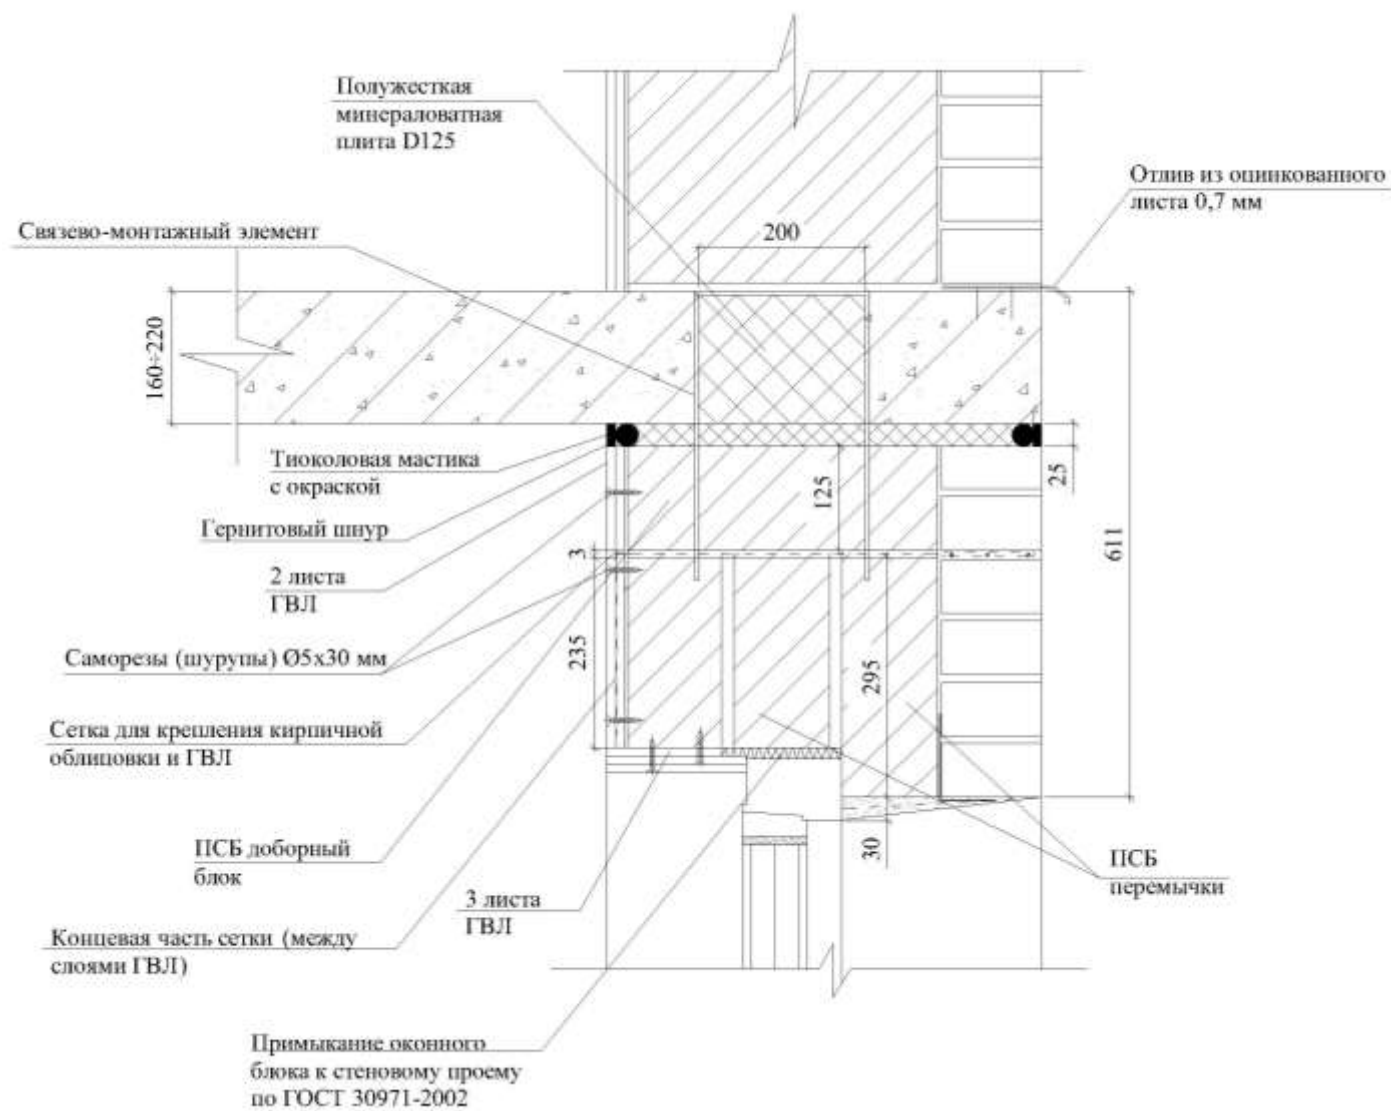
Крепление ГВЛ к кладке из ПСБ блоков с использованием штукатурной сетки
